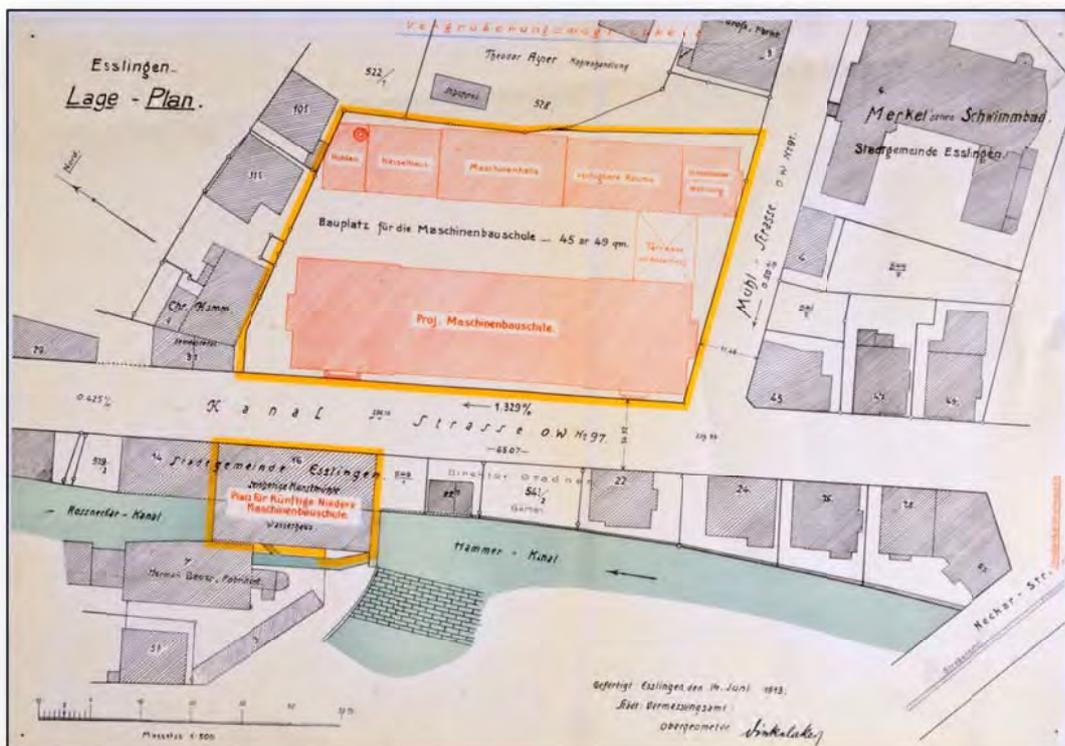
Lageplan-Zeichnung von 1913 mit dem Bebauungsprojekt Maschinenbauschule
